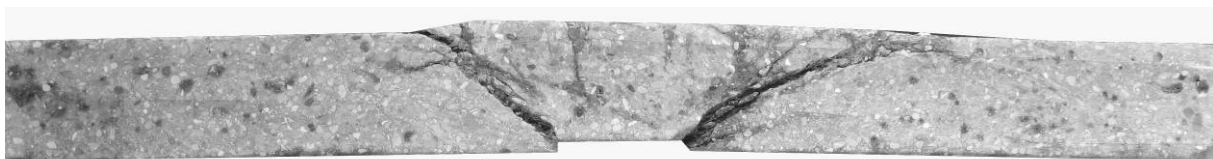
Fissuration à plusieurs niveaux de charge et fissures internes de la dalle B4-01.
